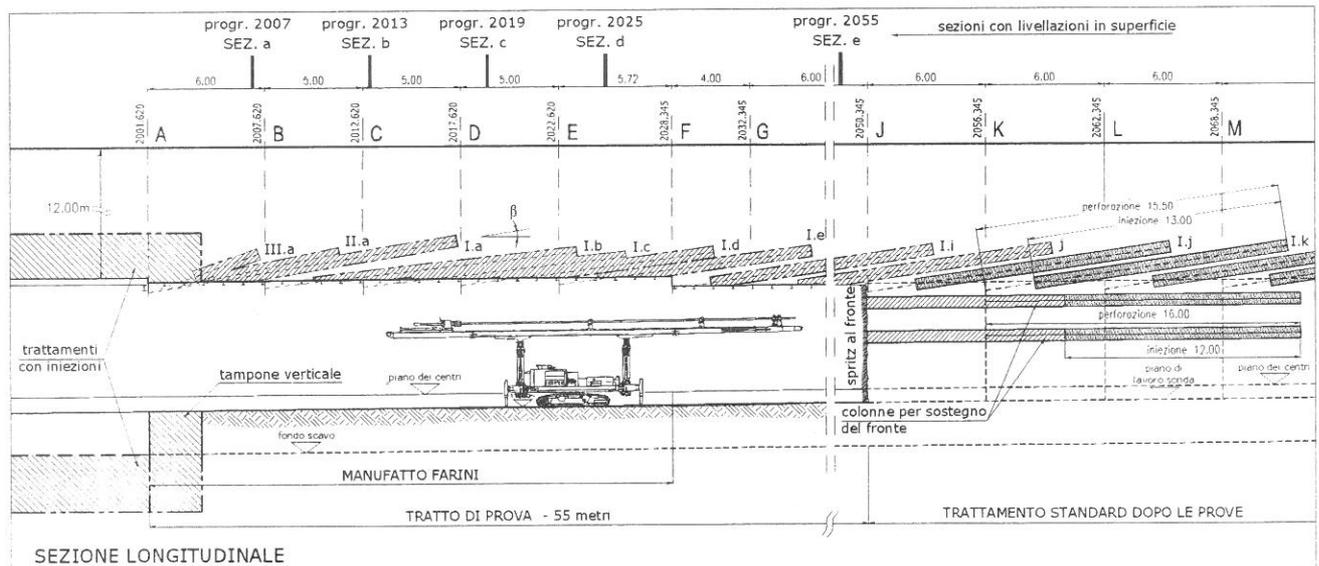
Consolidamento in avanzamento con colonne di jet grouting monofluido eseguite dal fronte di scavo
